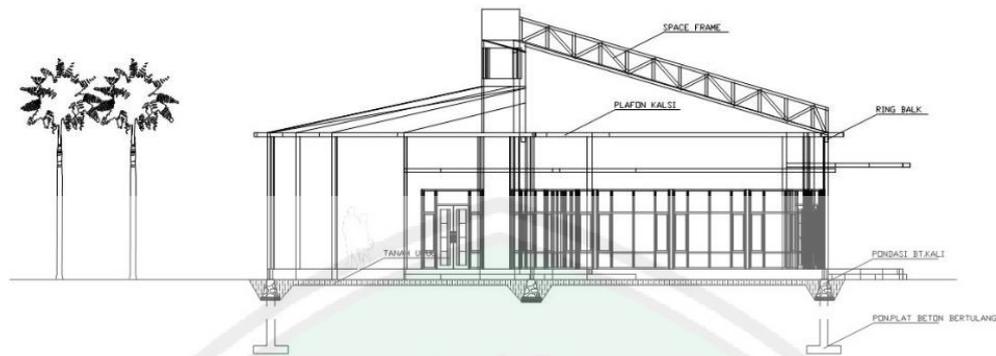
Tampak dan potongan depan bangunan pameran dan penelitian bersama
